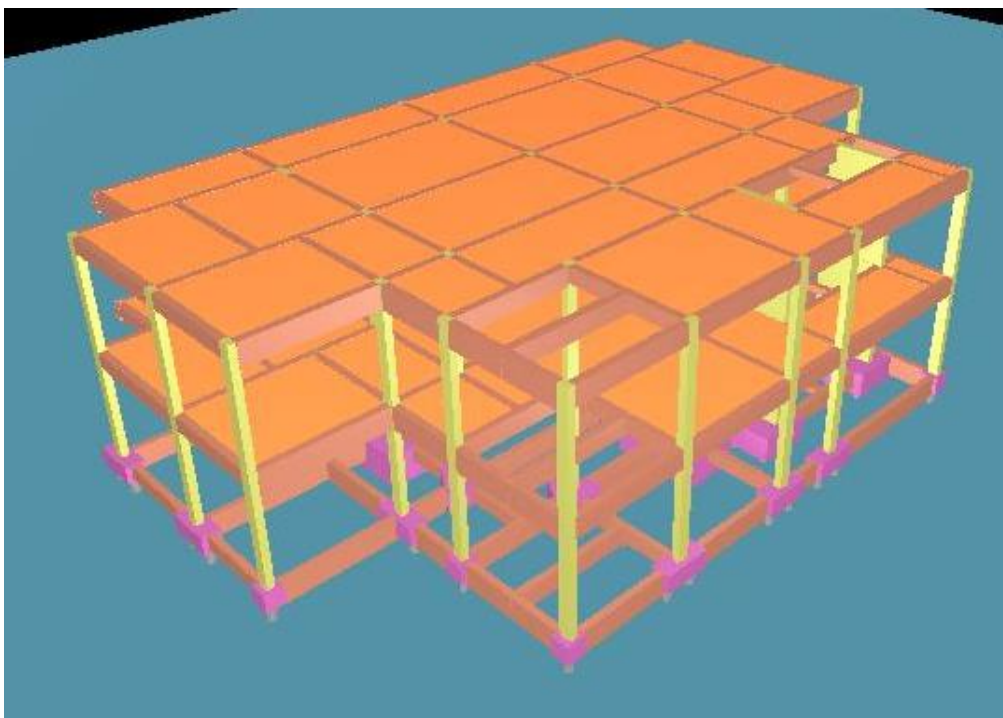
Forma da Fundação Até o Segundo Pavimento
